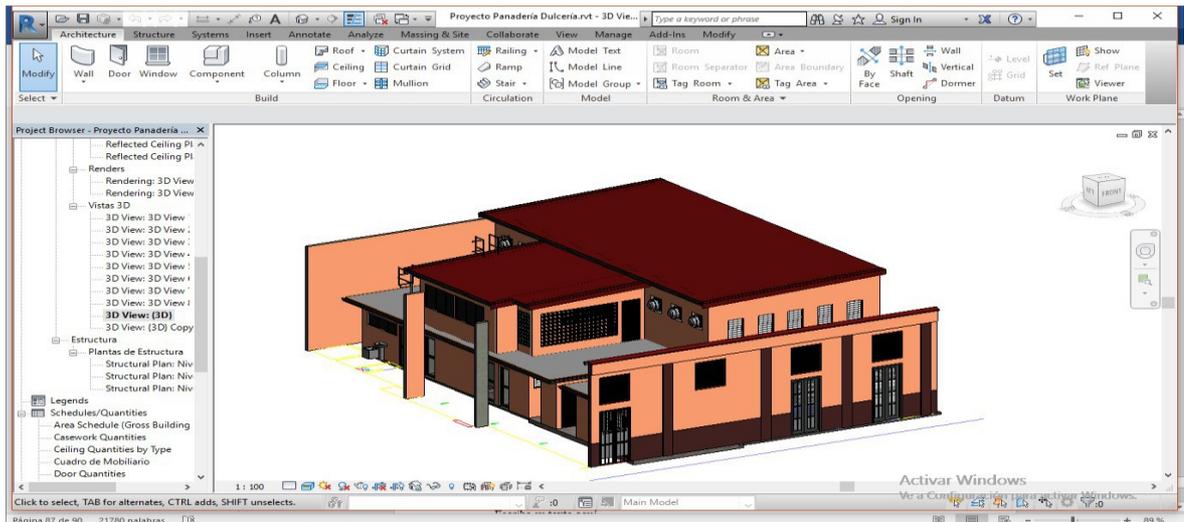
Modelo 3D realizado en REVIT. Fuente: Proyecto “Panadería Dulcería “Empresa IDEAR de Cienfuegos.
